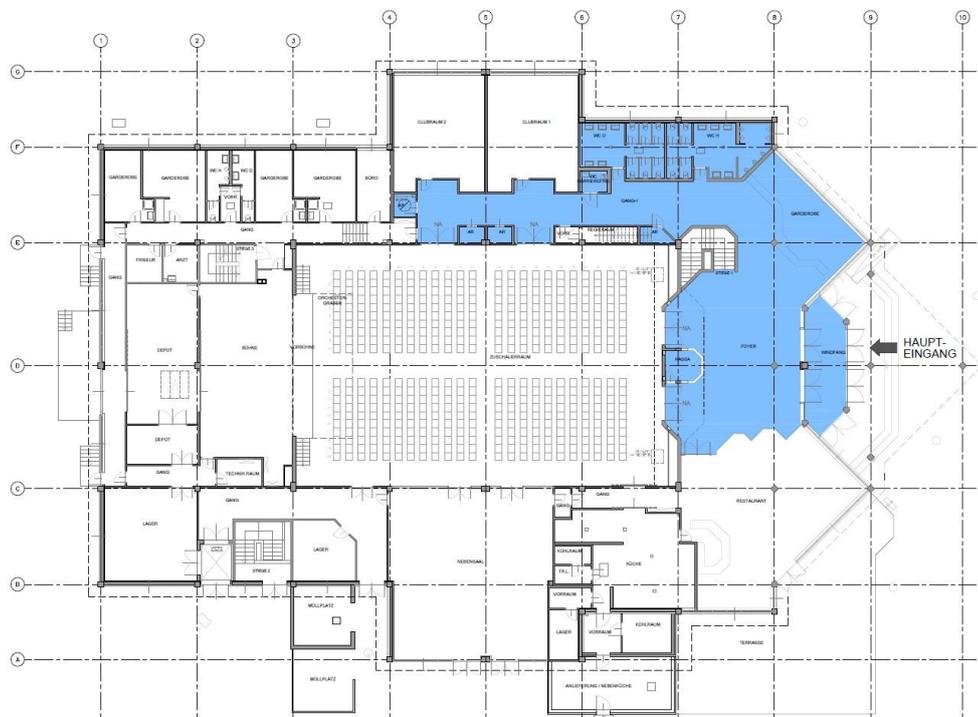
Übersichtsplan Erdgeschoss – Erschließungsbereich
